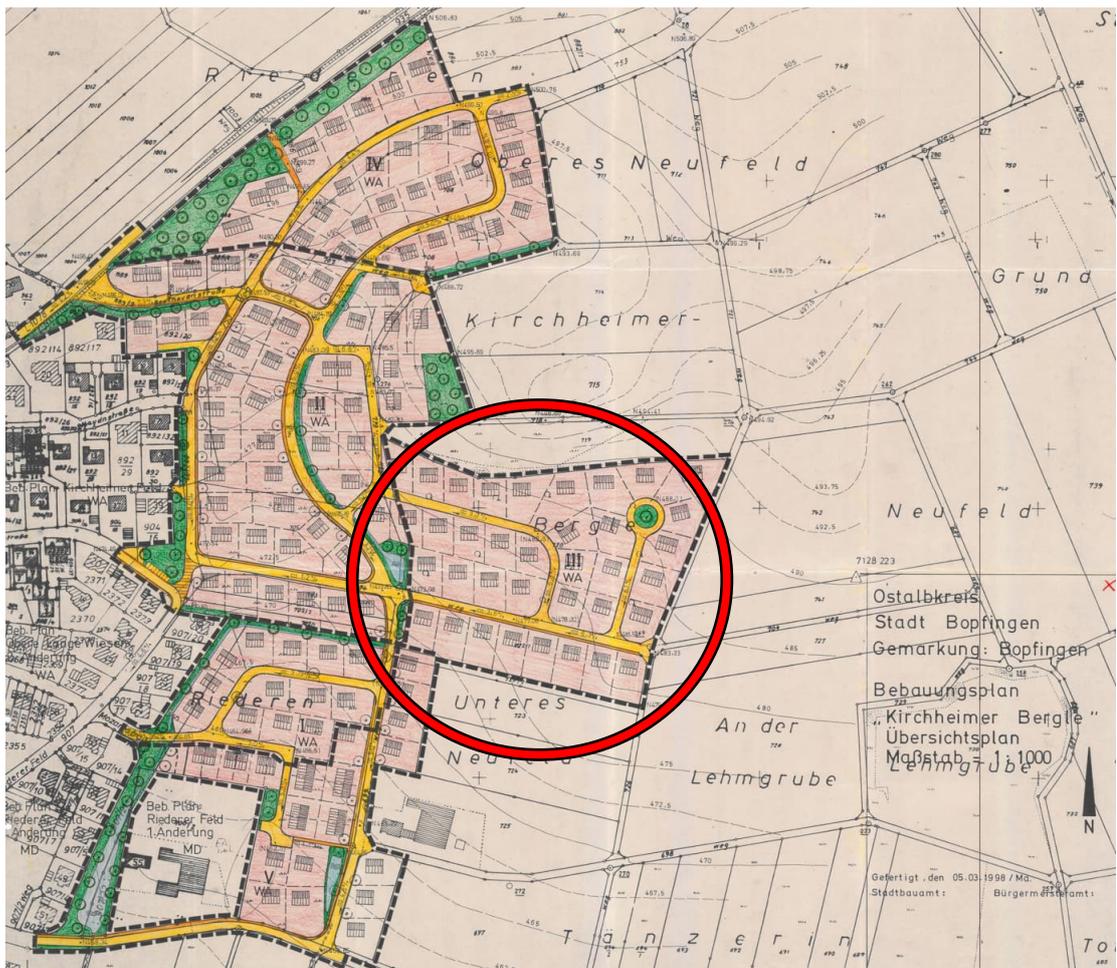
Städtebauliches Konzept „Kirchheimer Bergle“ der Stadt Bopfingen von 1998. Ergänzung durch HPC: Plangebiet mit roten Kreis gekennzeichnet.
